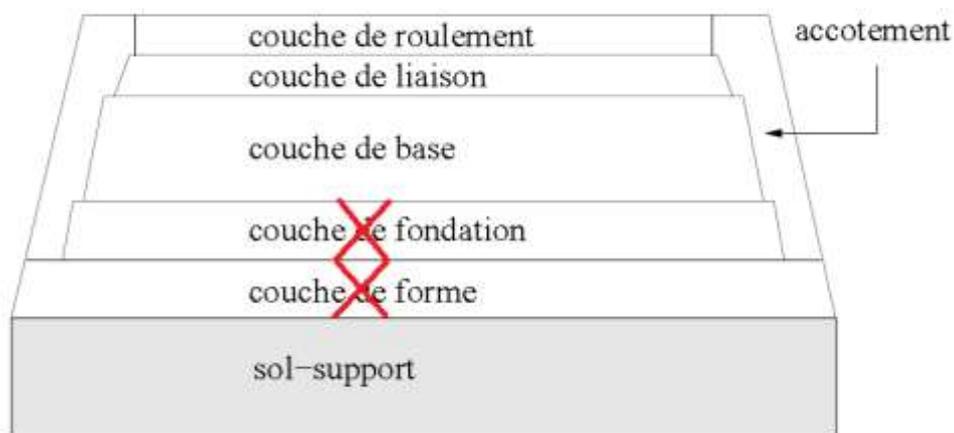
Constitution d'une structure de chaussée incomplète. LCPC, 1994.
